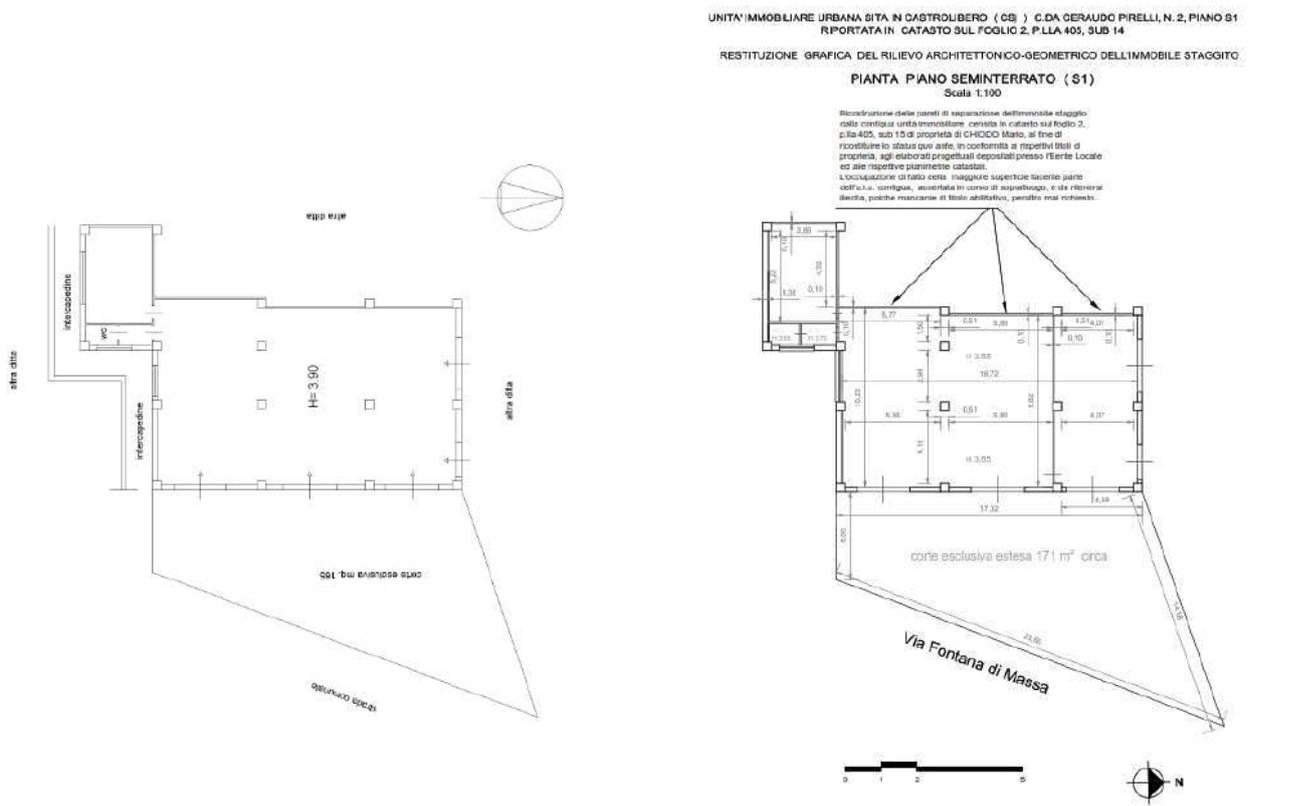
U.i.u. Fg 2,P.IIa405,Sub 14 - Estratto dalla planimetria catastale
